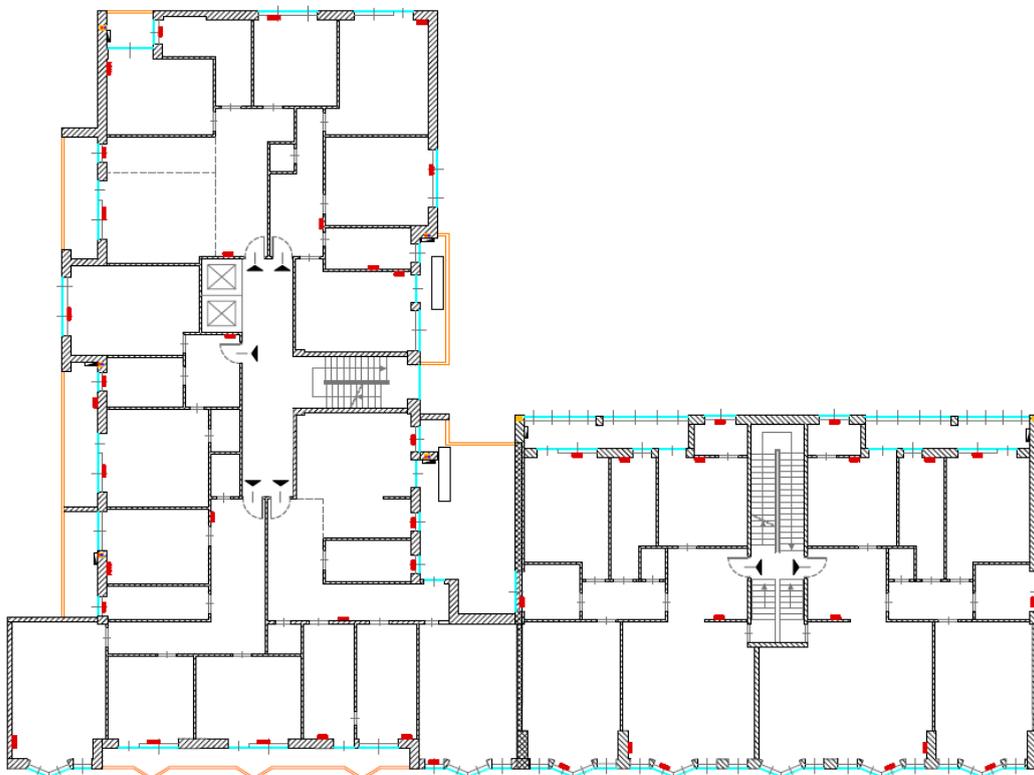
Pianta completa primo piano edifici n.35 e n.35-bis
